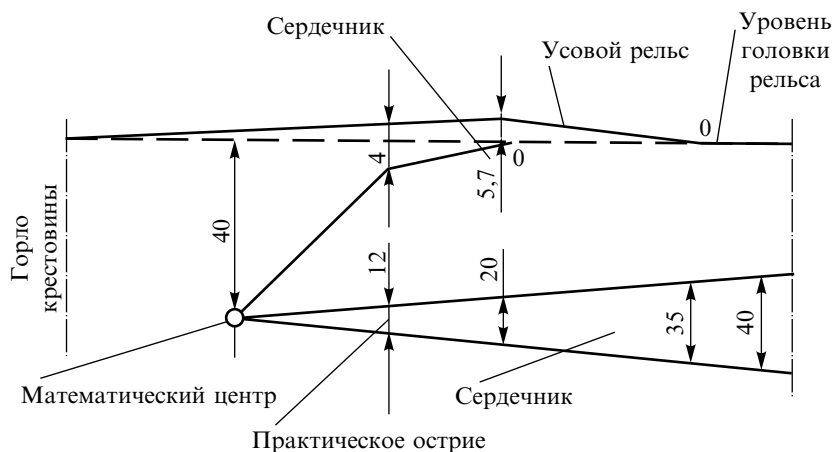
Продольный профиль цельнолитой и сборной крестовины типа общей отливки сердечника с изнашиваемой частью острия
